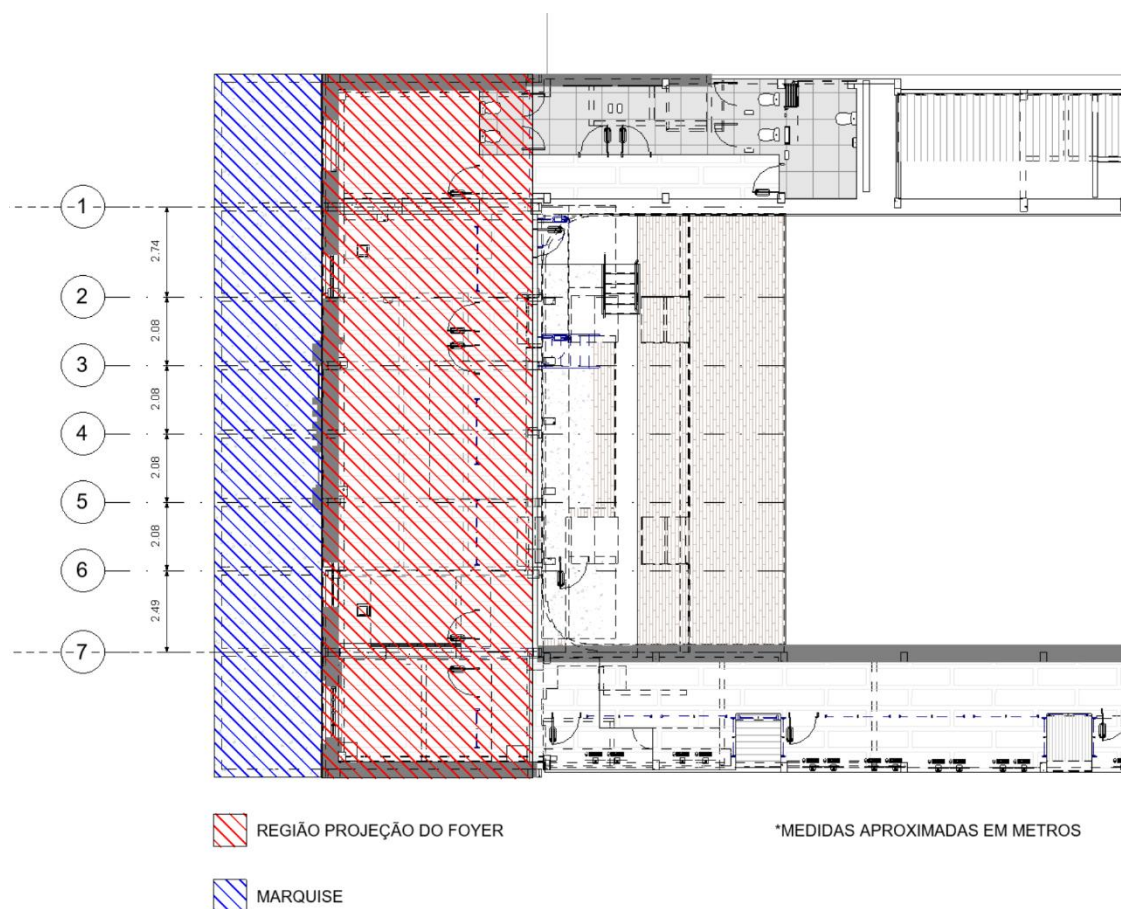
Indicação das Áreas de realização dos levantamentos da estrutura “As Built”
